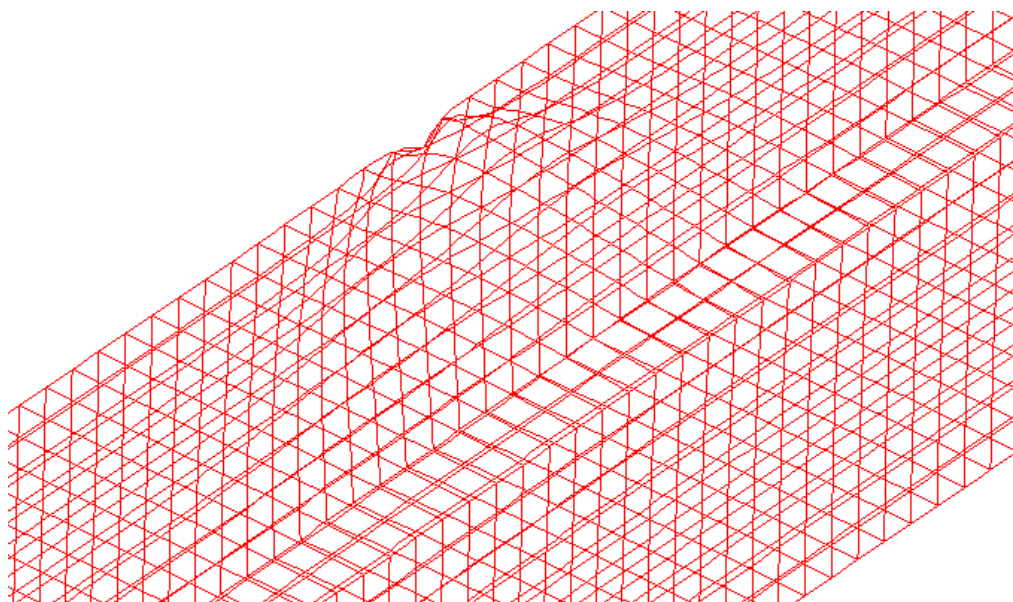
Vista 3D – Superfície de Influência – Barra Transversal – Centro – Centro do vão da Laje Superior
